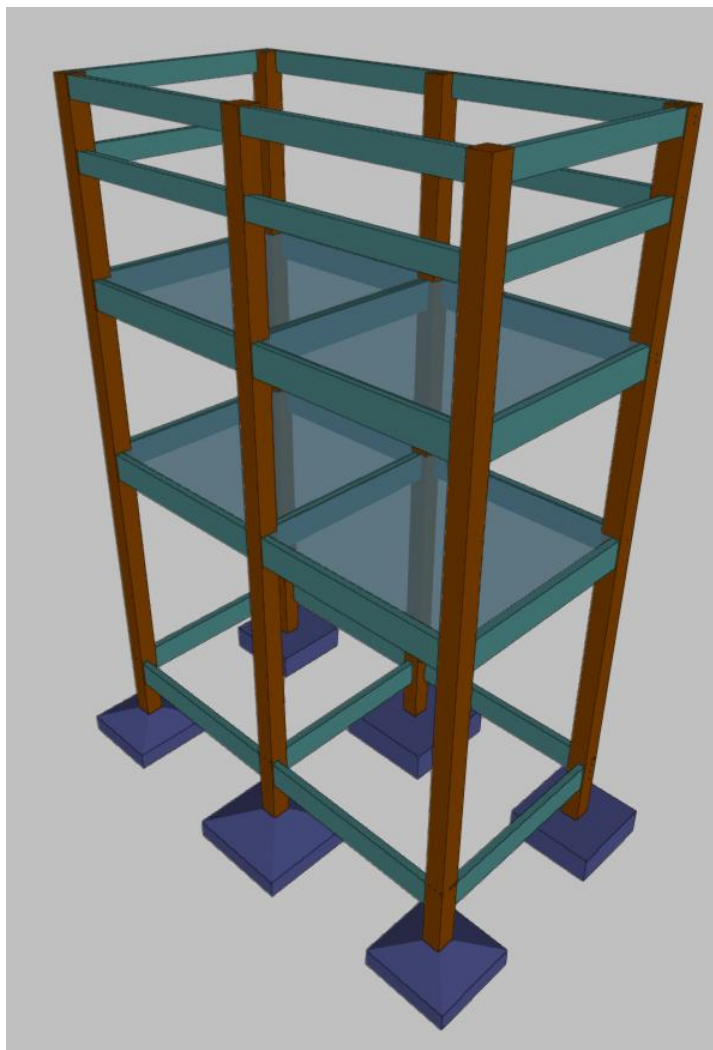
Castelo D'água – Modelo estrutural 3D vista 1
